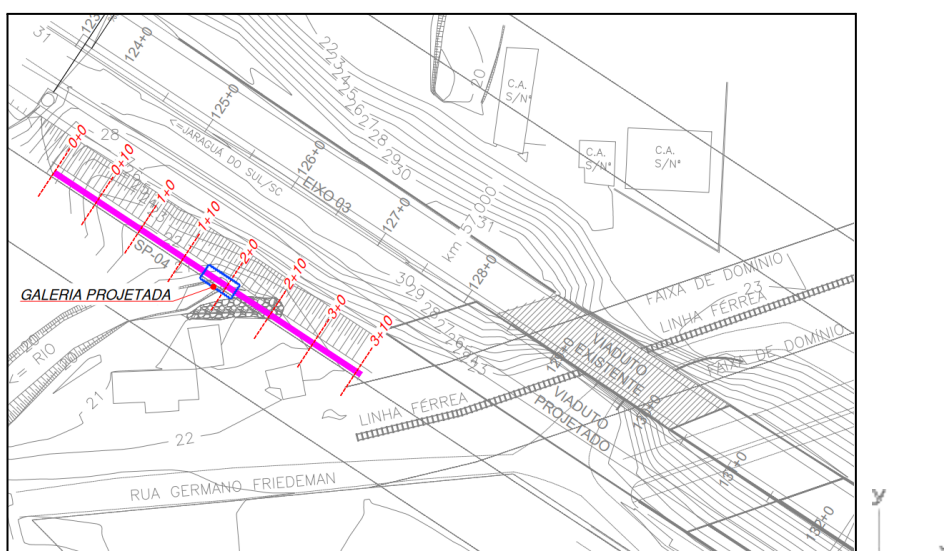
Planta Baixa do viaduto Linha Férrea.
